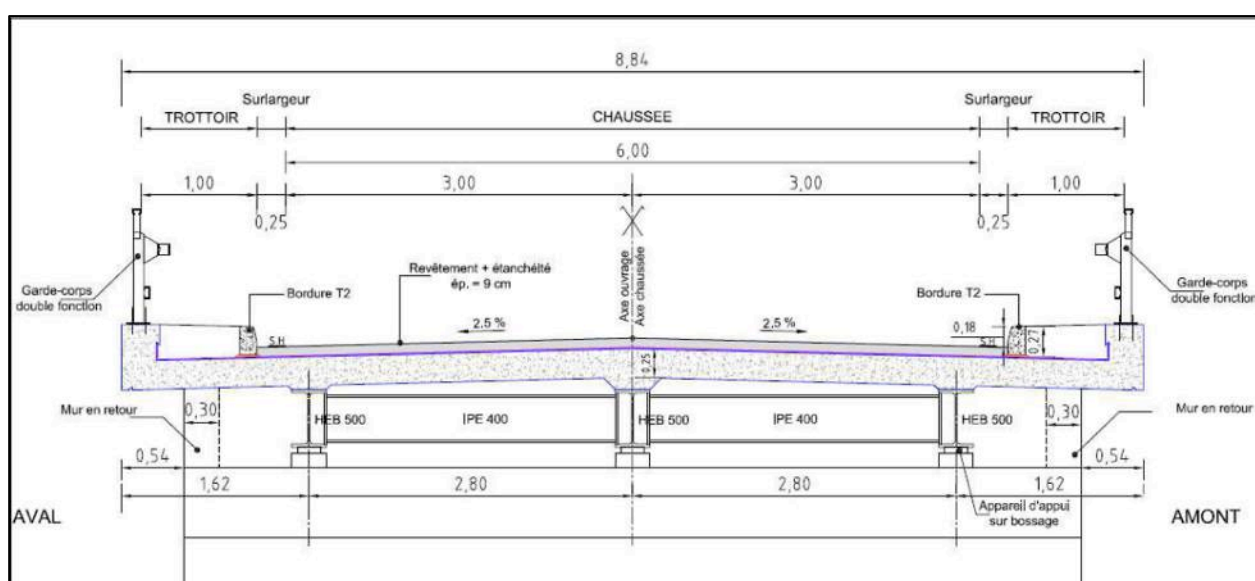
vue du profil en travers sur la section du futur ouvrage (source : DEPS, 2016)
